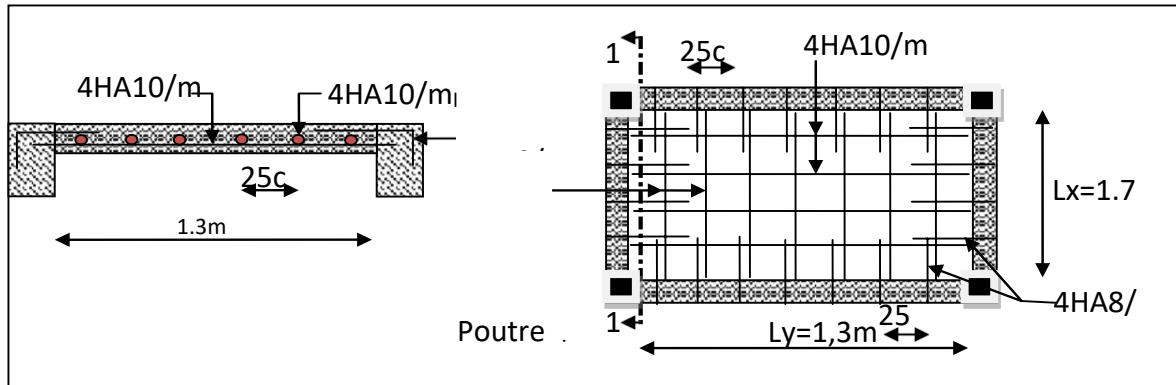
Schéma de ferrailage dalle pleine du locale machinerie
